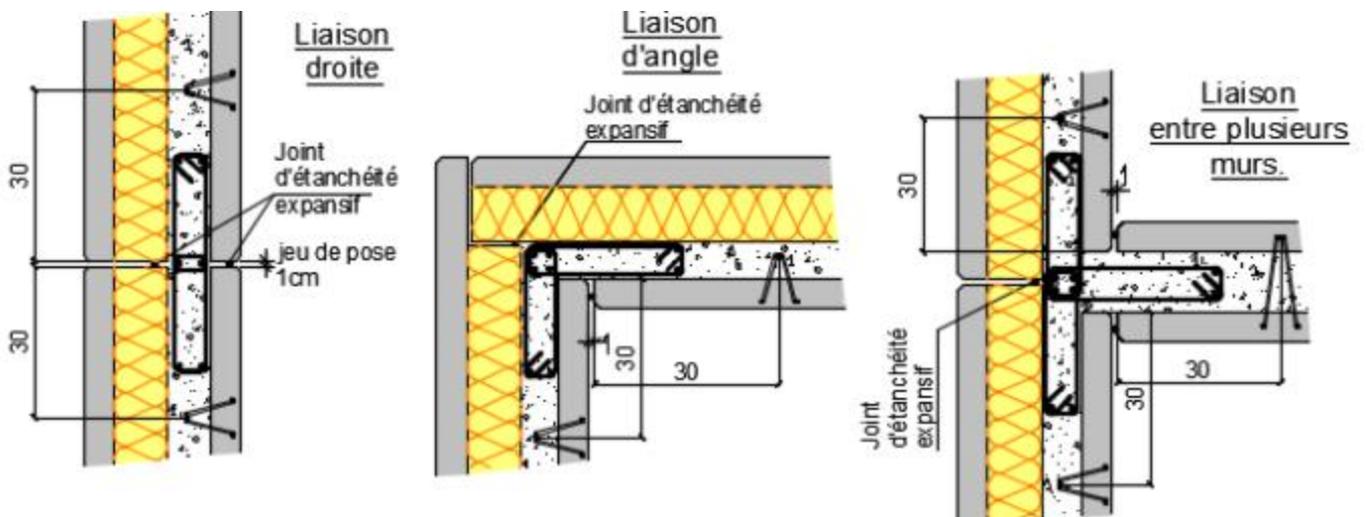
LIAISONS VERTICALES ARTICULEES ENTRE MURS AVEC EP BETON COULE SUR PLACE ≥ 8 CM
